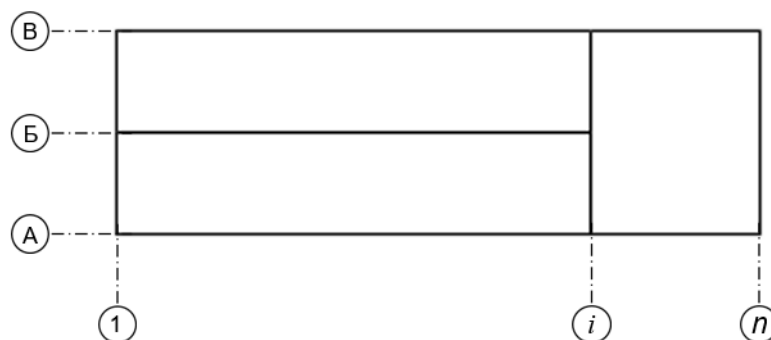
Схематичний план промислової будівлі для 1 варіанту
